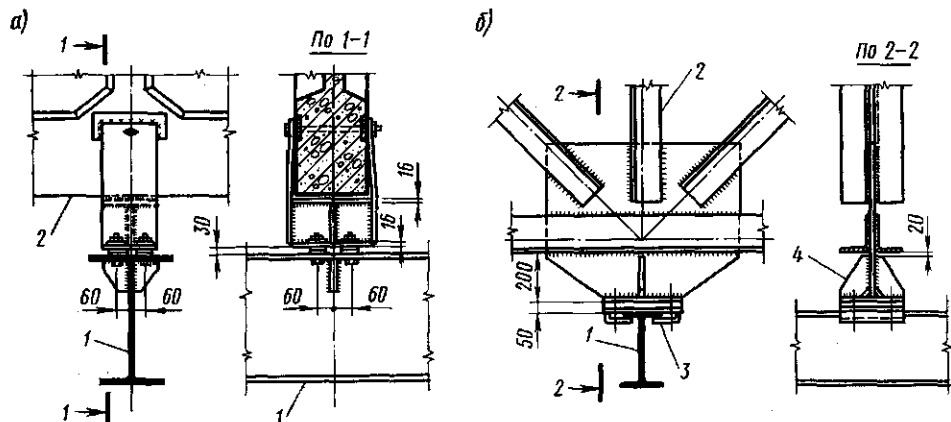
Крепление подвесных путей к стропильным конструкциям:
